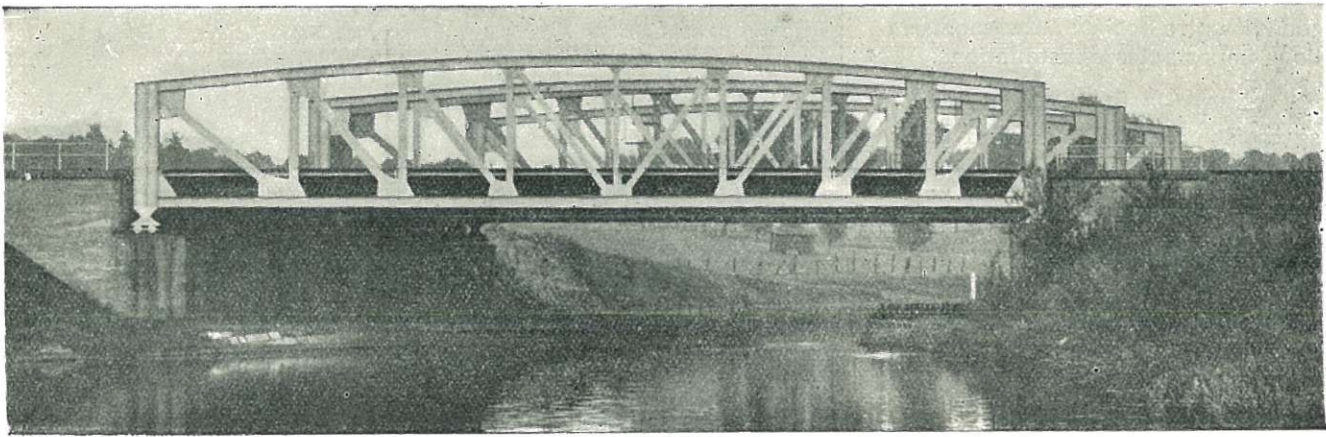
Entre Courcelles Motte et La Chaussée. — Nouveau pont au-dessus du canal.
